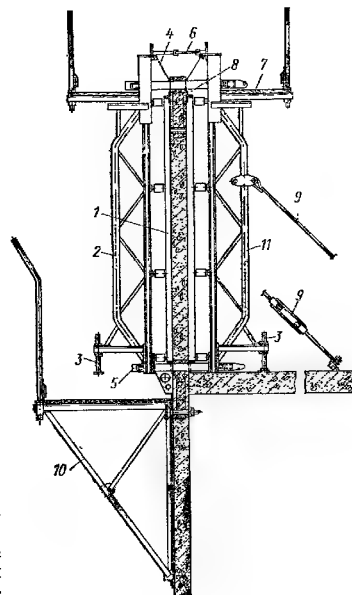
Унифицированная крупнощитовая опалубка конструкции ЦНИИОМТП:
